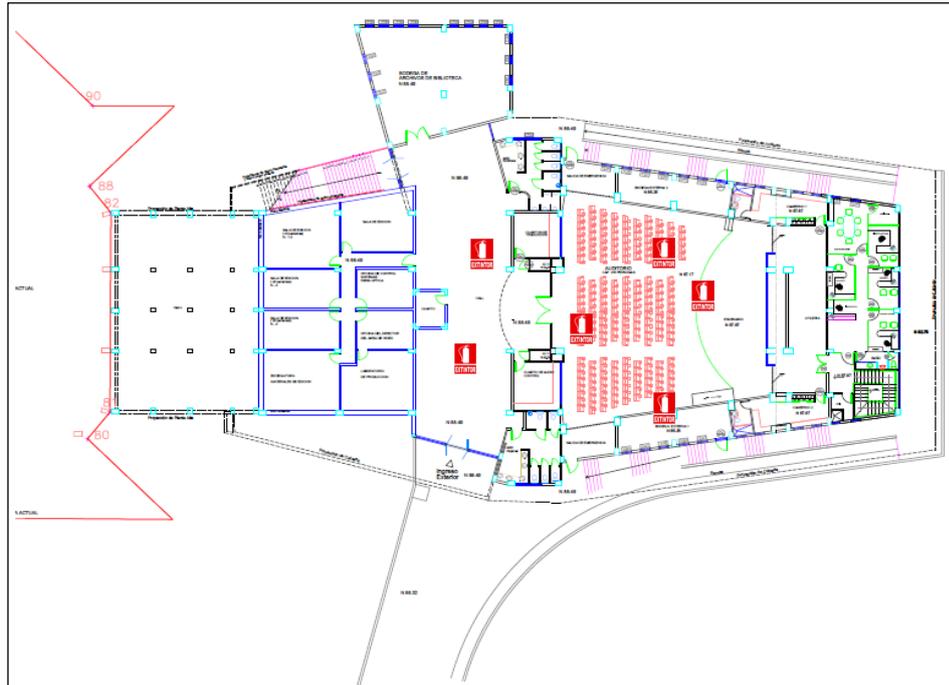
Extintores, Ampliación de Edificio-Planta Baja, Zona 6
